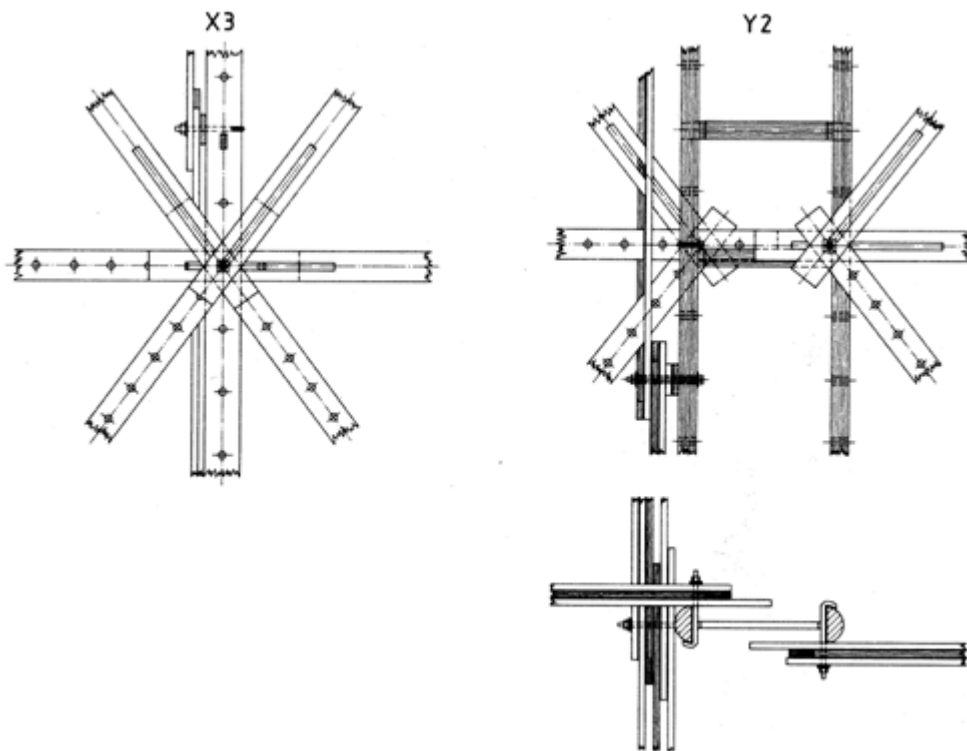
(Fortsetzung) Raumgerüst (siehe [Abschnitt 5.2](#))
